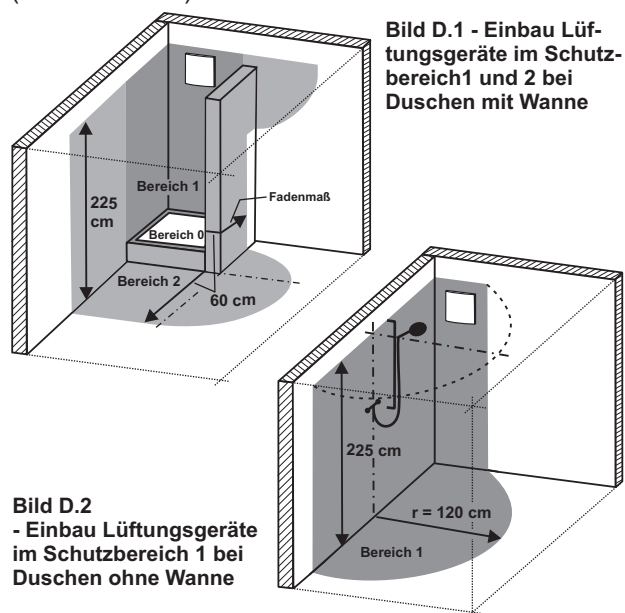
Einbau Lüftungsgeräte im Schutzbereich 1 und 2 bei Duschen mit Wanne
